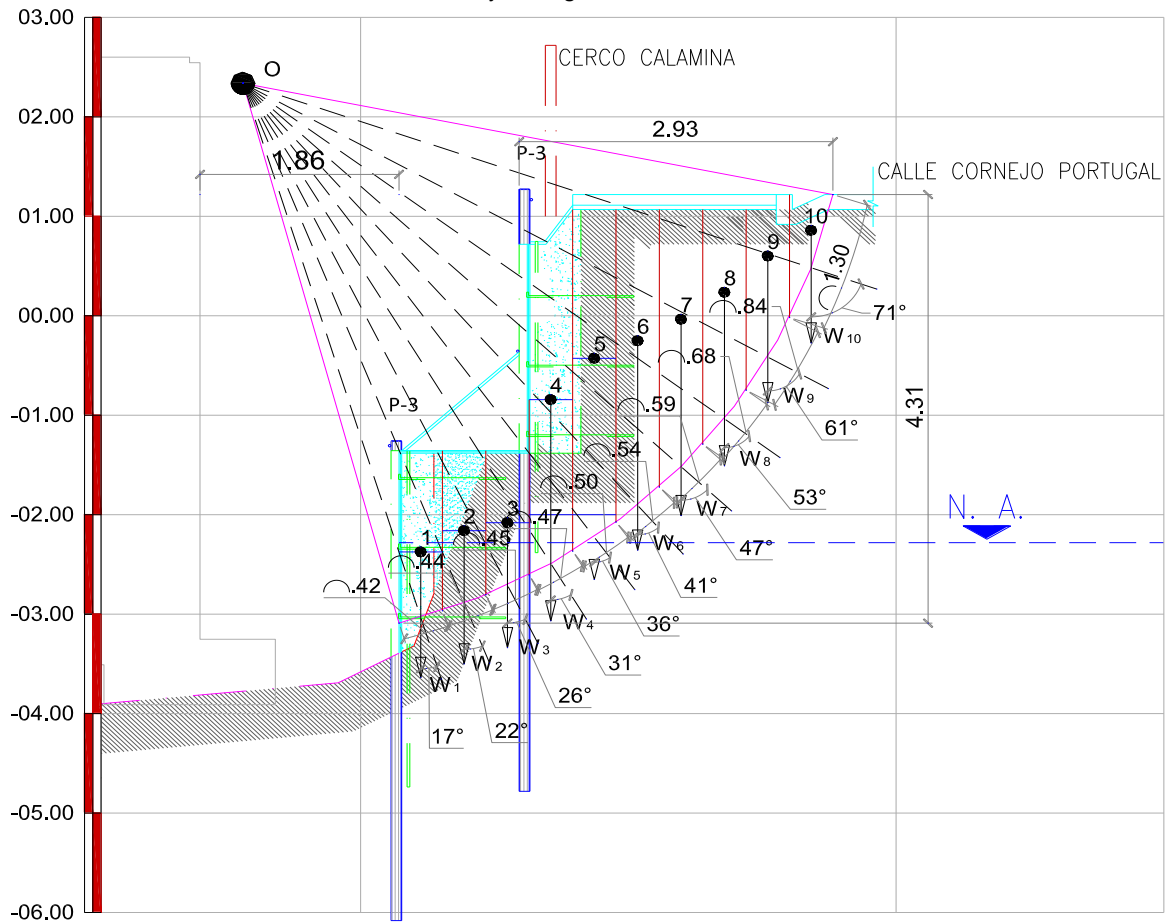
Plano de falla 3 estabilizado con el modelo propuesto.
